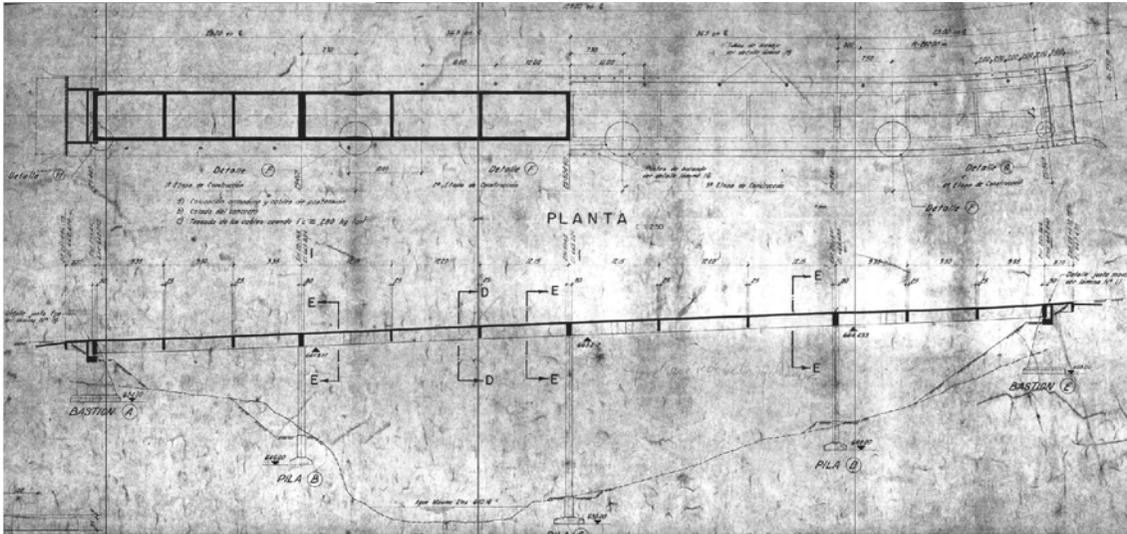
Sección longitudinal del puente sobre el río Rosales.
